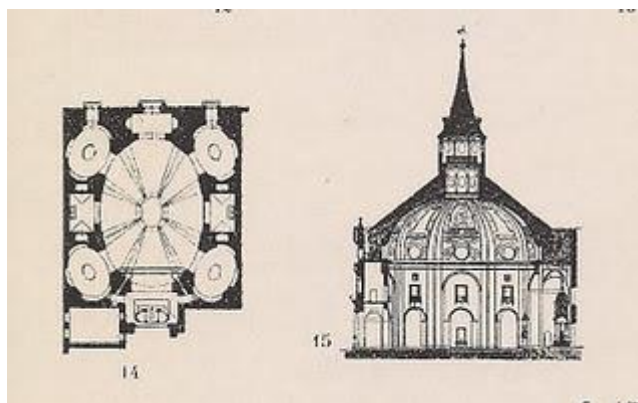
Planta y alzado de la iglesia de las Bernardas Reales de Alcalá de Henares.
